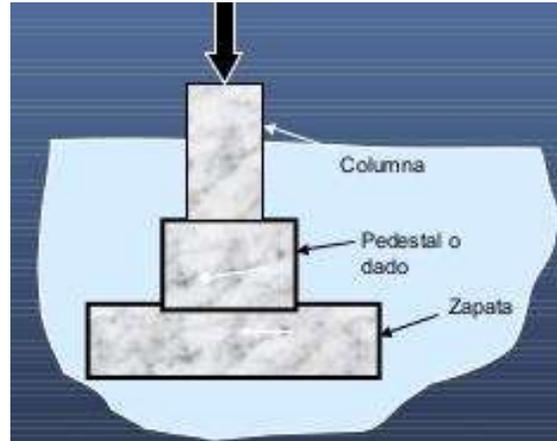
; zapata aislada, tomada de: <https://es.slideshare.net/leones2011/cimentaciones-16607189>
